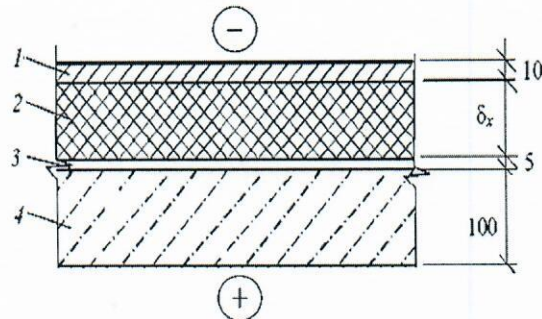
Вариант 1-й конструкции чердачного перекрытия:
